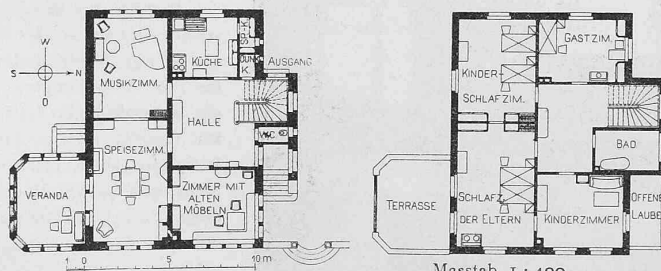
und 3. Grundrisse vom Erdgeschoss und ersten Obergeschoss.
